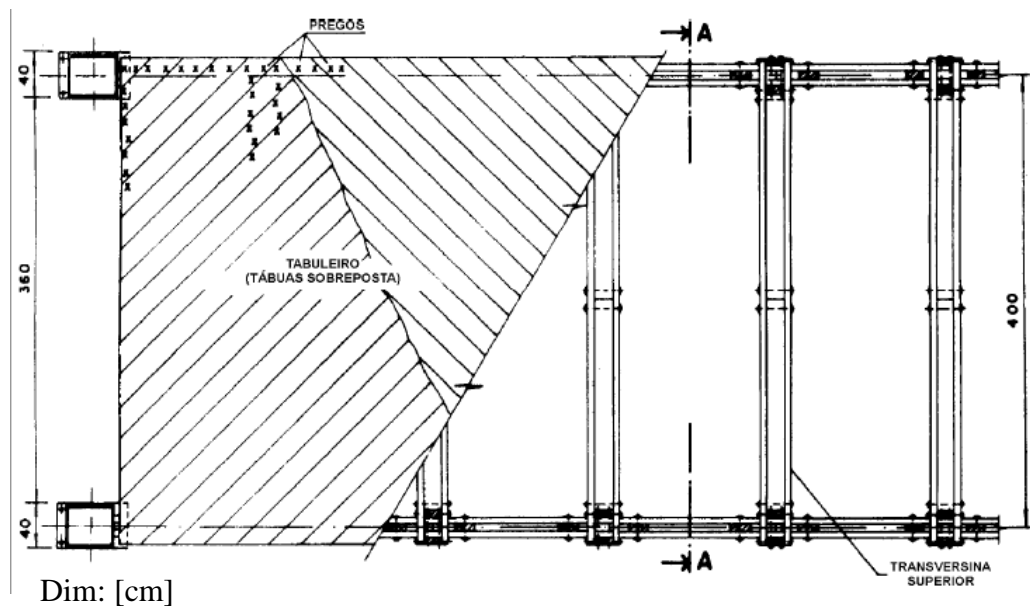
Vista em planta (Revista Madeira, 2001)
